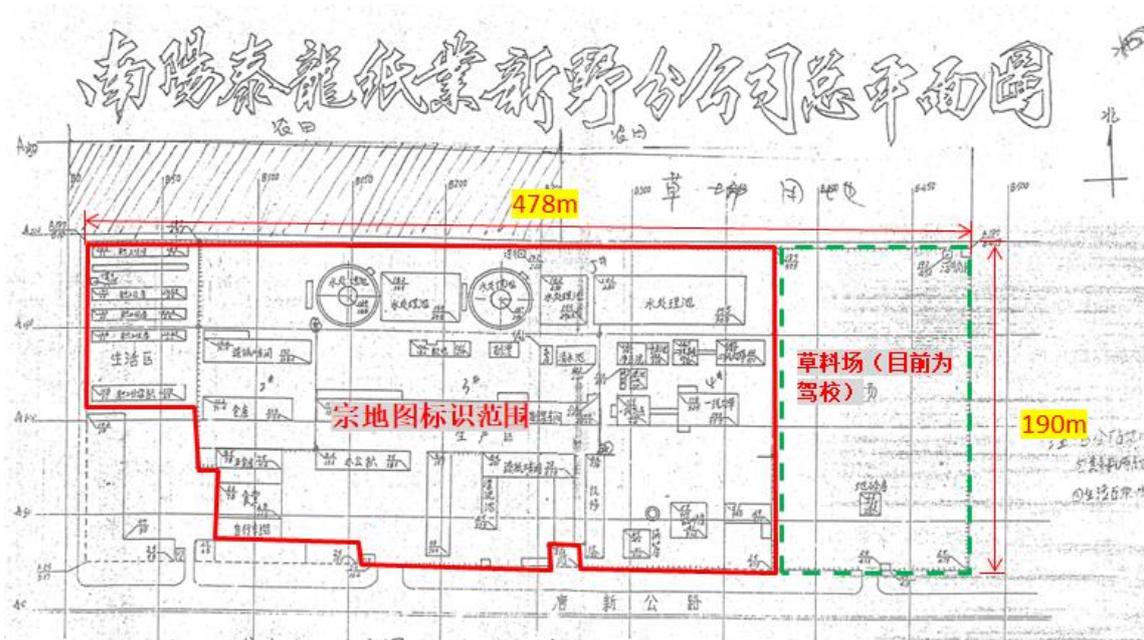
南阳泰龙纸业新野有限公司平面布置图
